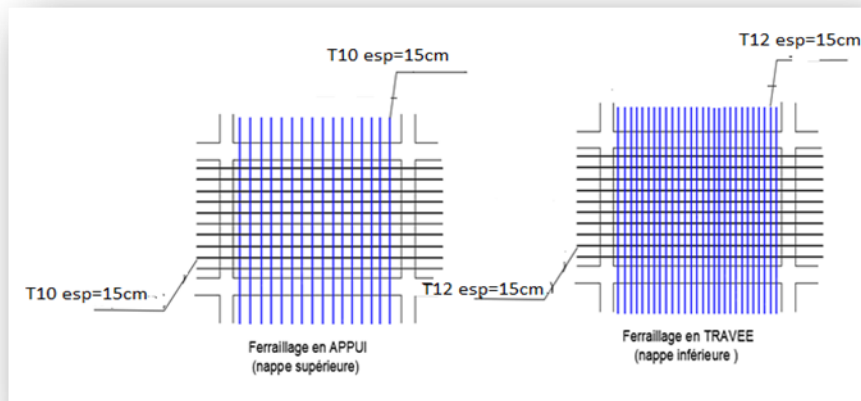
Ferrillage de la dalle pleine 1<sup>er</sup> étage.
